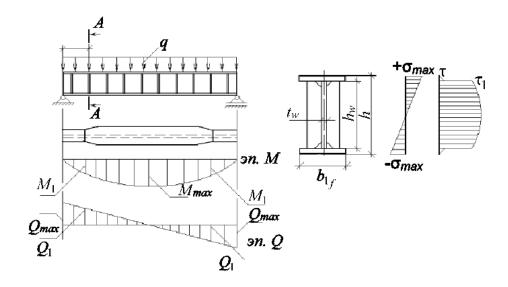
Расчетные схемы к изменению сечения поясов главной балки
